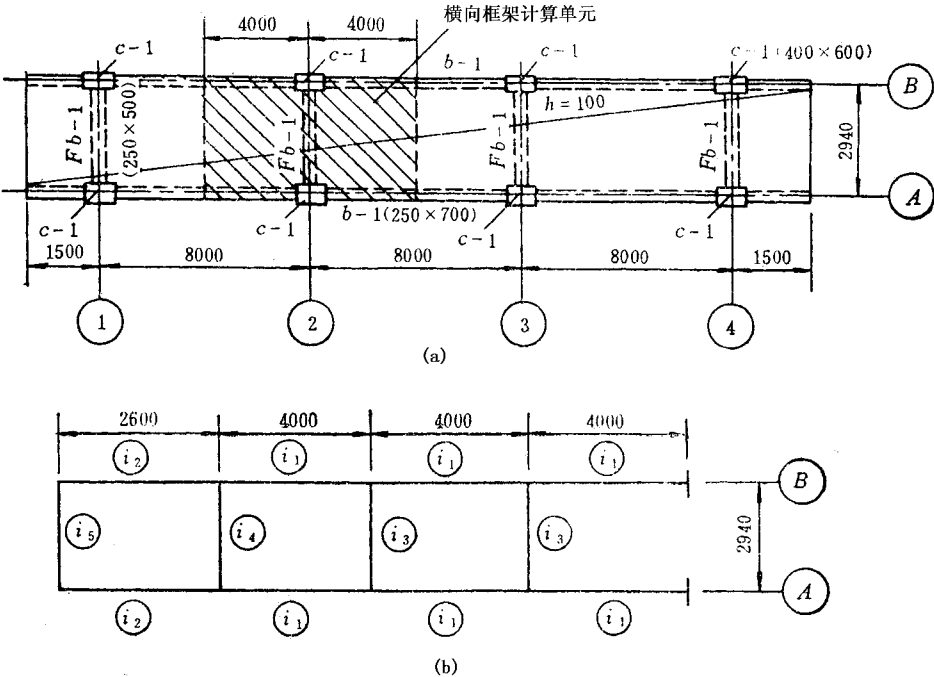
钢筋混凝土走廊计算单元及计算模型
